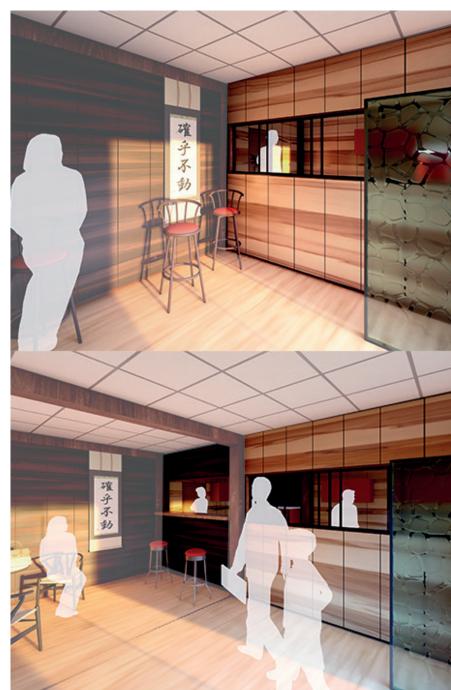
Imagen Obejtivo del sistema constructivo de tabiqueria flexible para caso de elasticidad de espacio. Fuente: Elaboación Propia
